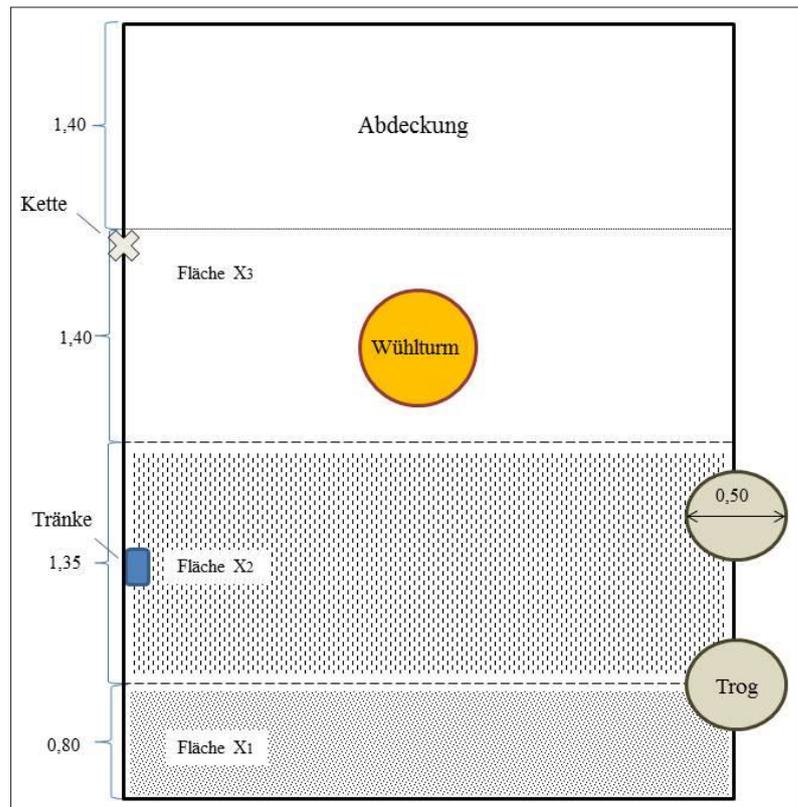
Zweiflächenbucht Aufzucht (Liegebereich X3 Beton planbefestigt; Kotbereich Betonspalten X2 und Kotbereich Gussroste X1)
